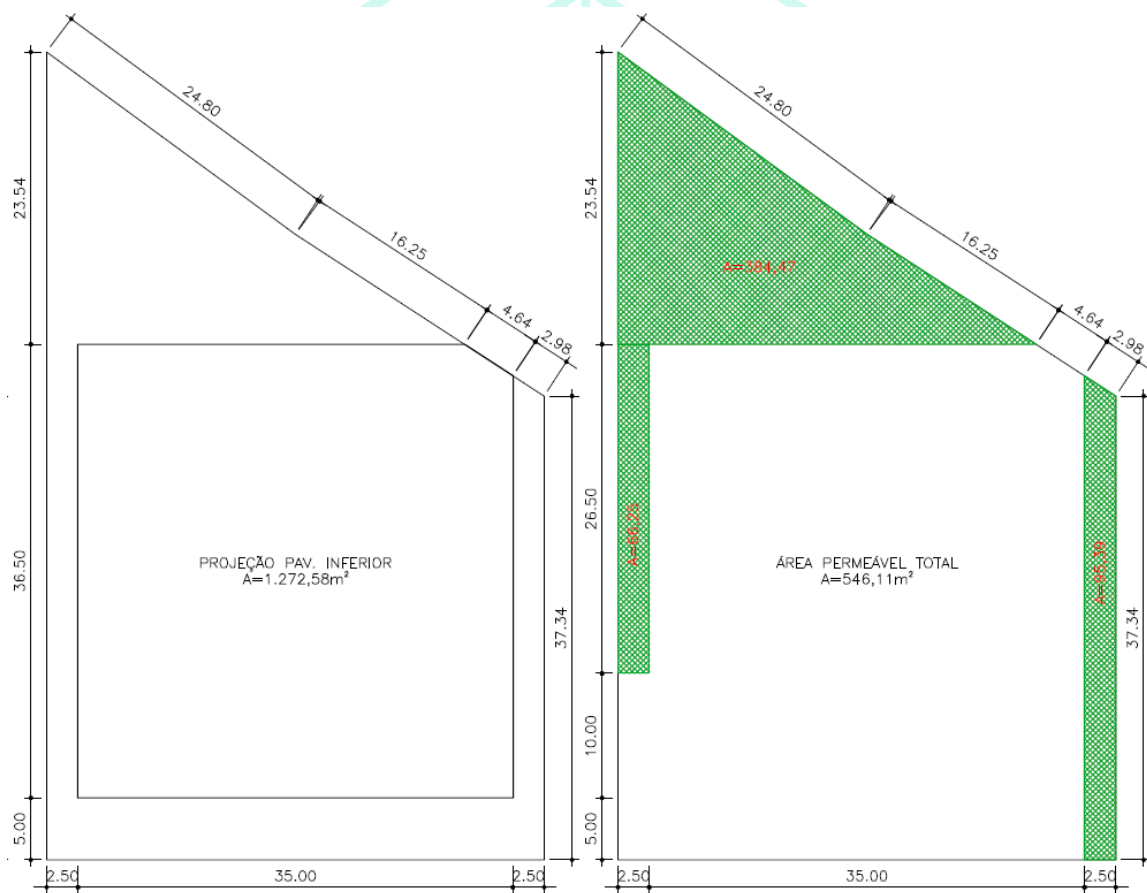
CROQUI DA PROJEÇÃO DO PAVIMENTO INFERIOR E DA ÁREA PERMEÁVEL
